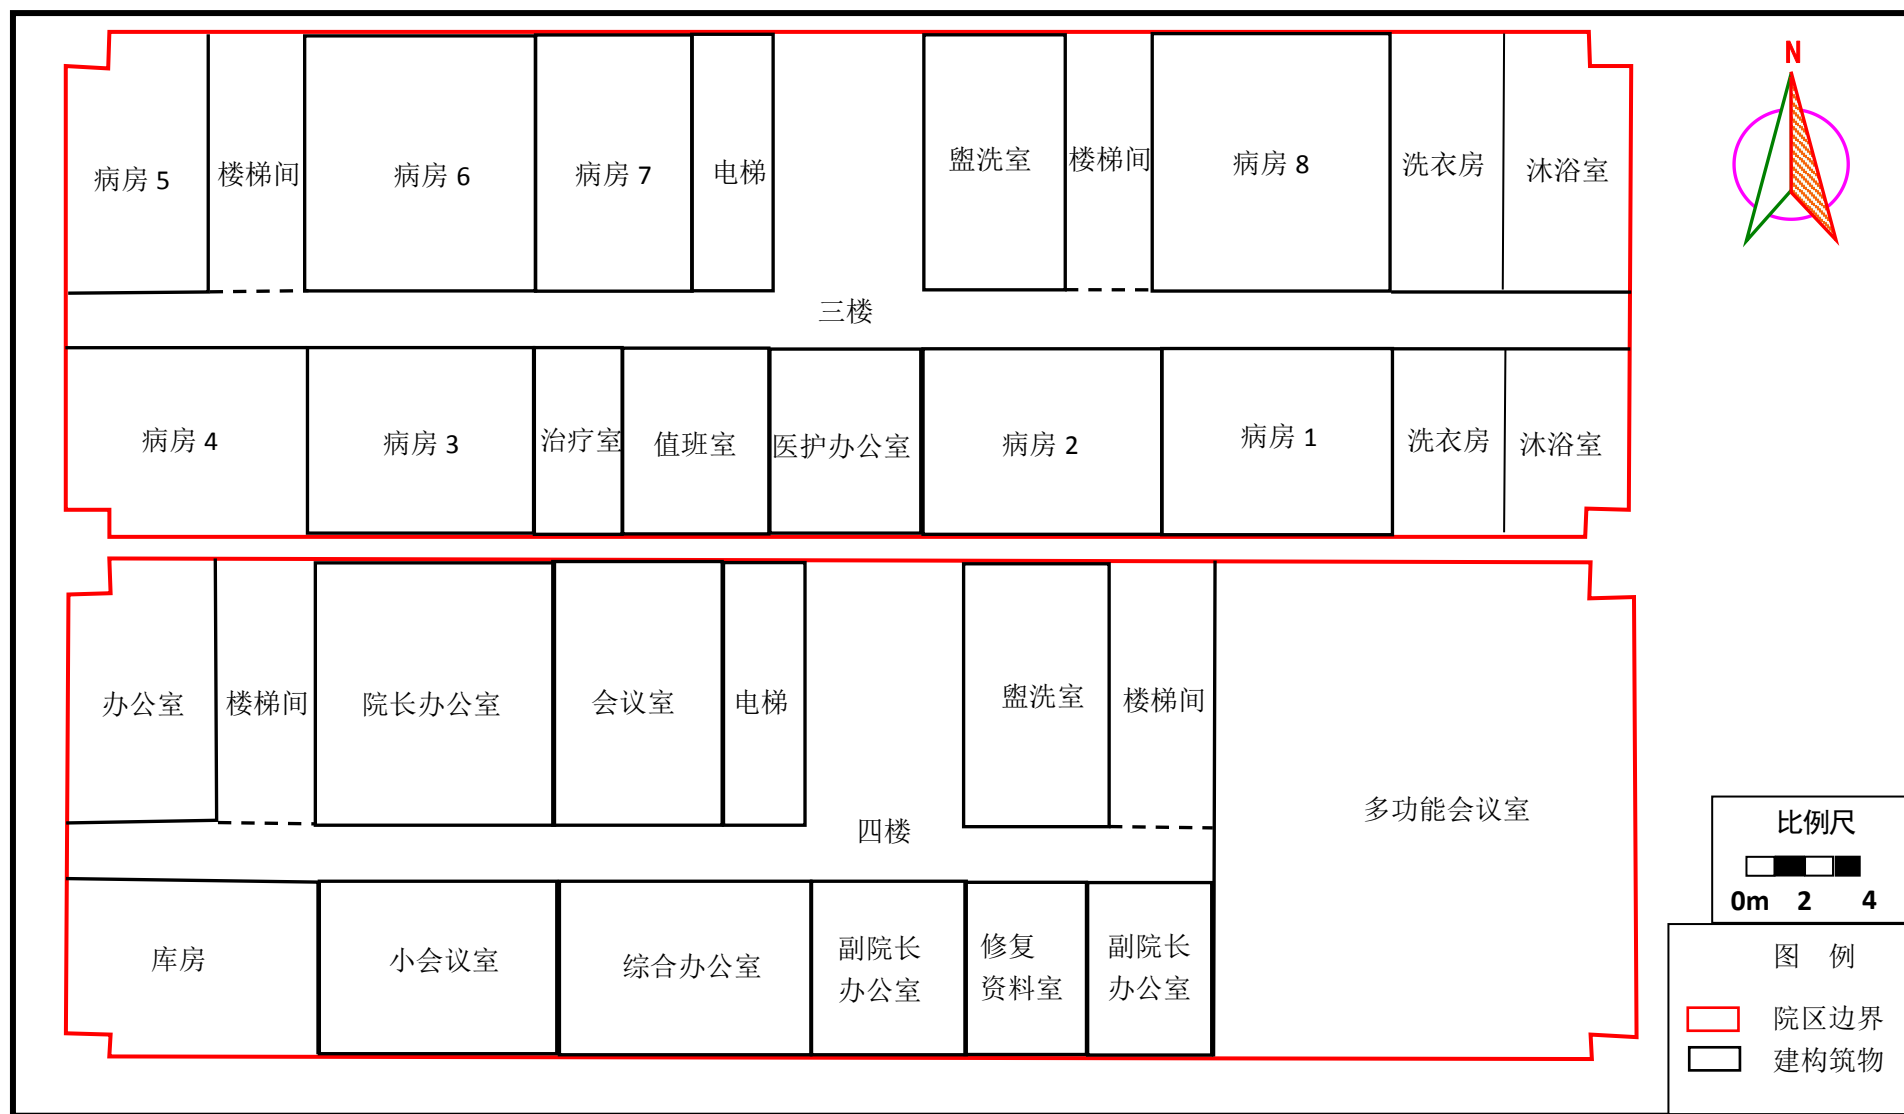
项目门诊综合楼三楼、四楼平面布置图
